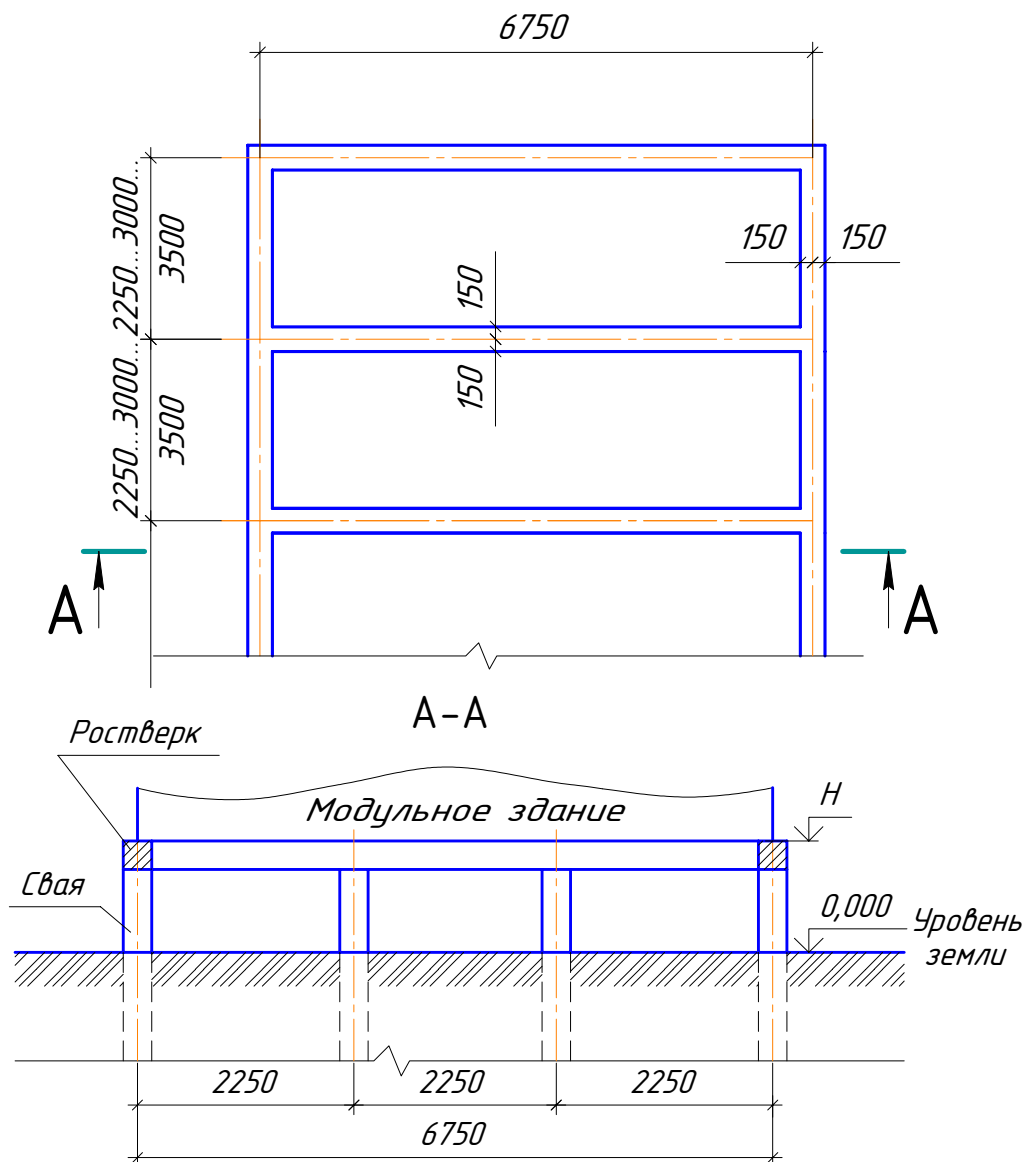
Схема плана ростверка под модульное здание (точный размер тела ростверка определяется расчетом)
